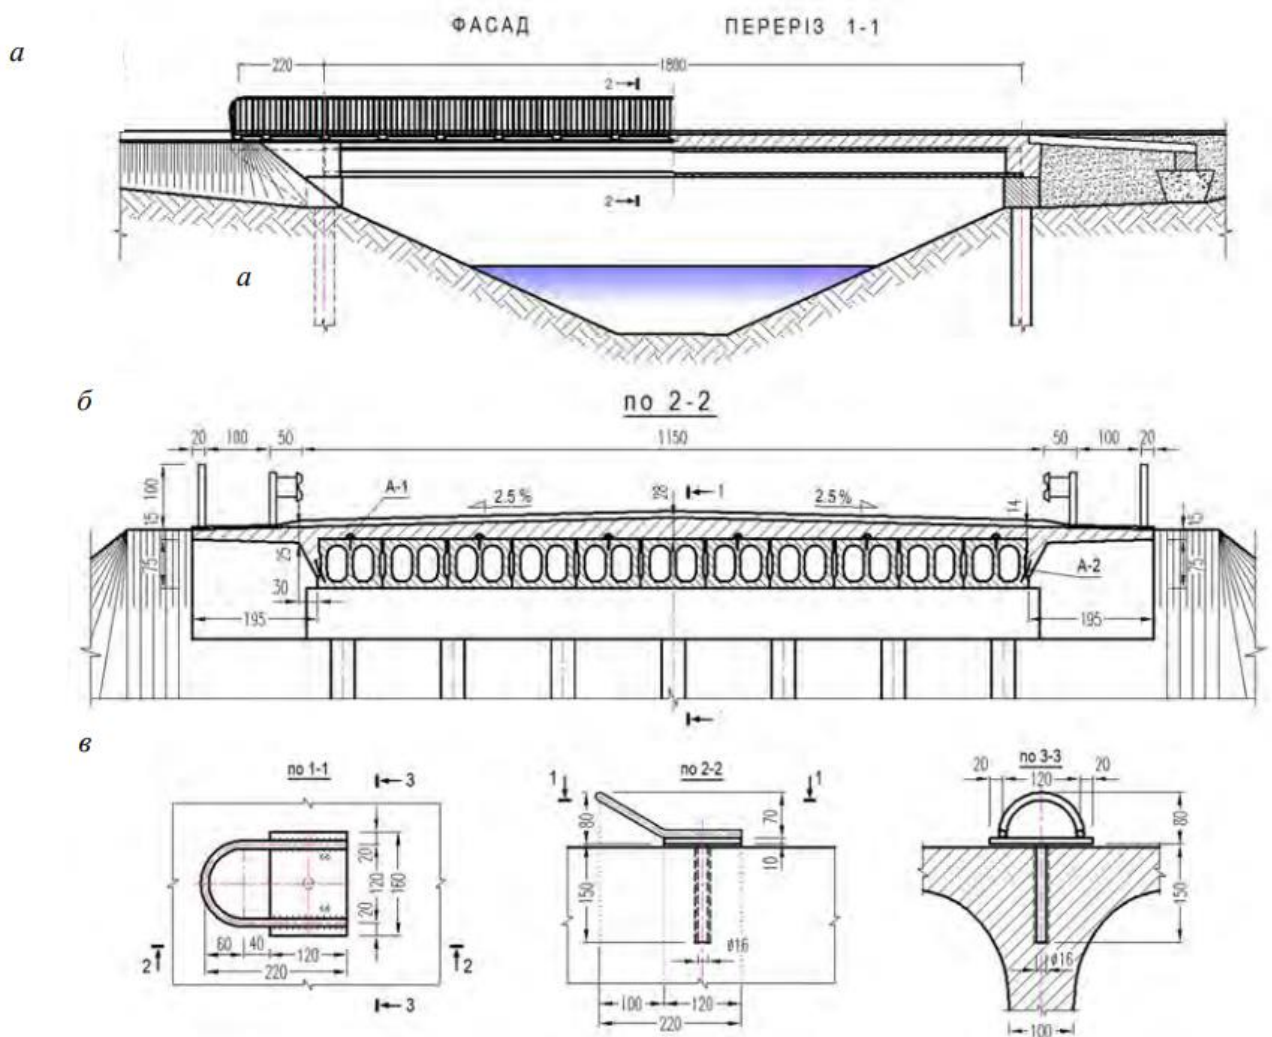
Приклад реконструкції мосту через р. Перга: а – фасад і поздовжній переріз; б – поперечний переріз розширеного прольоту; в – анкери
